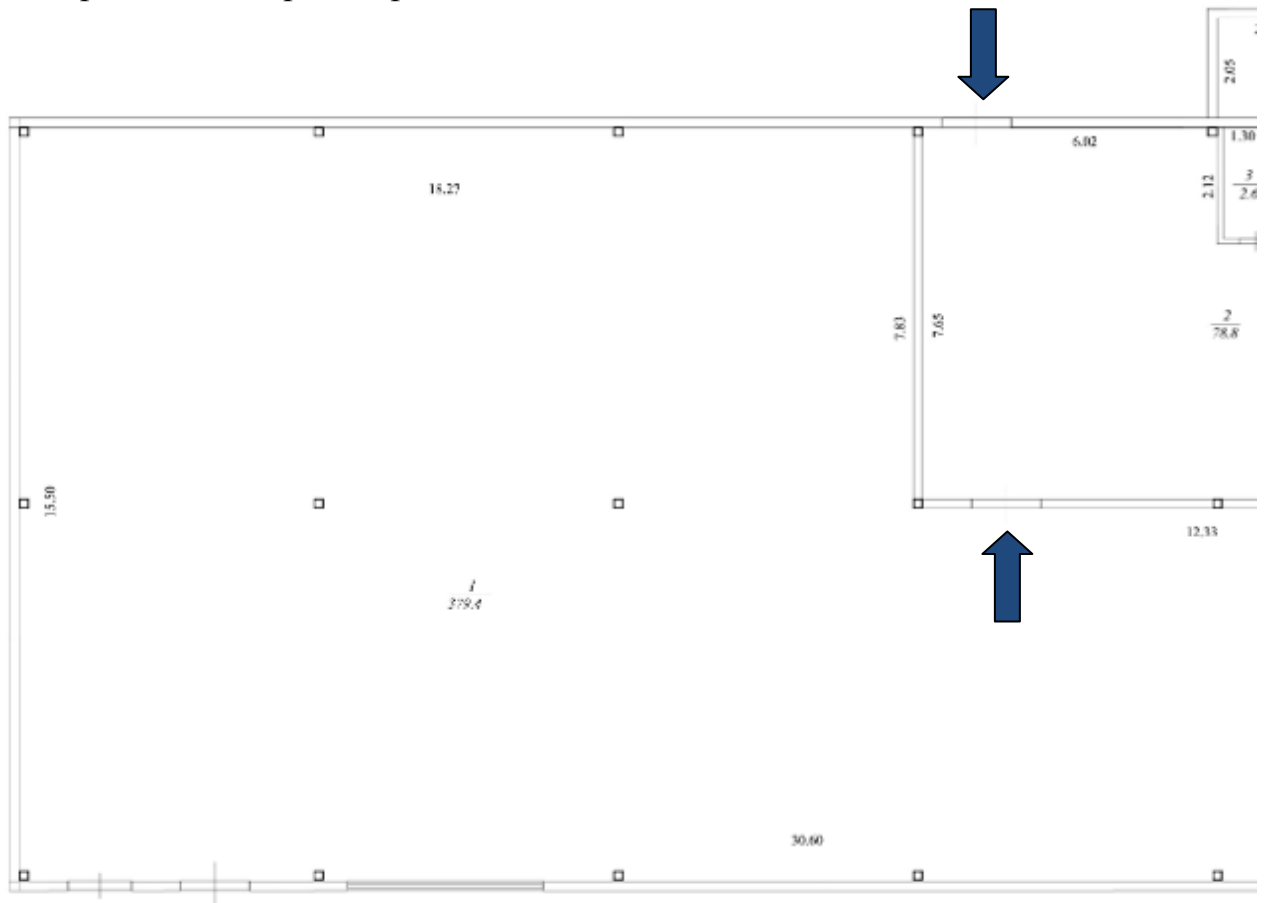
на Плана этажа использован условный знак, проема без установления дверей, ворот
